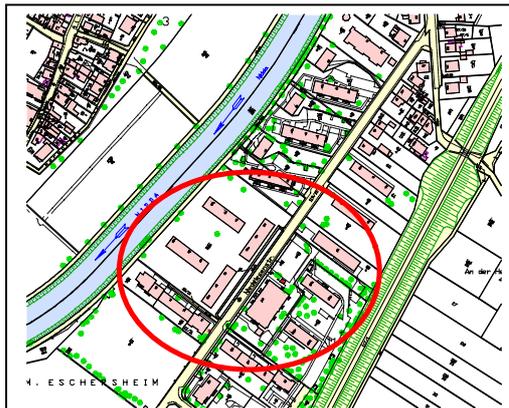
Lageplan Nahwärmegebiet Niedwiesenstraße
